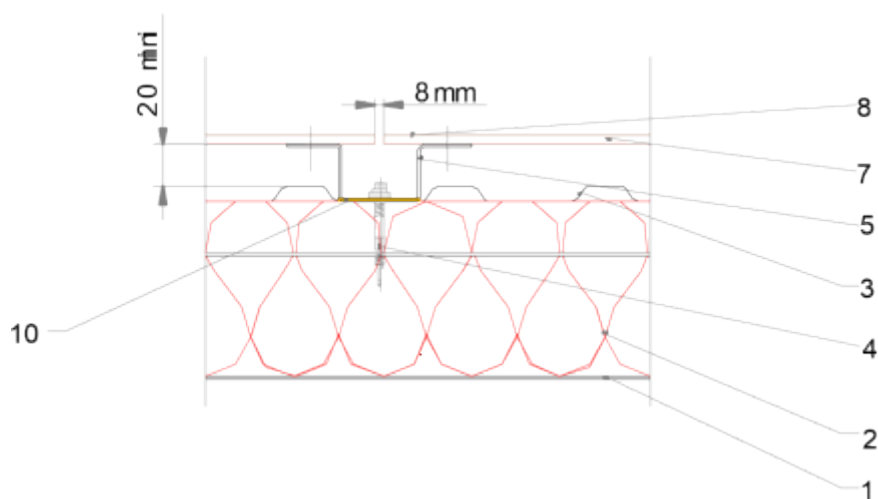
Jonction entre panneaux EQUITONE – Coupe horizontale
